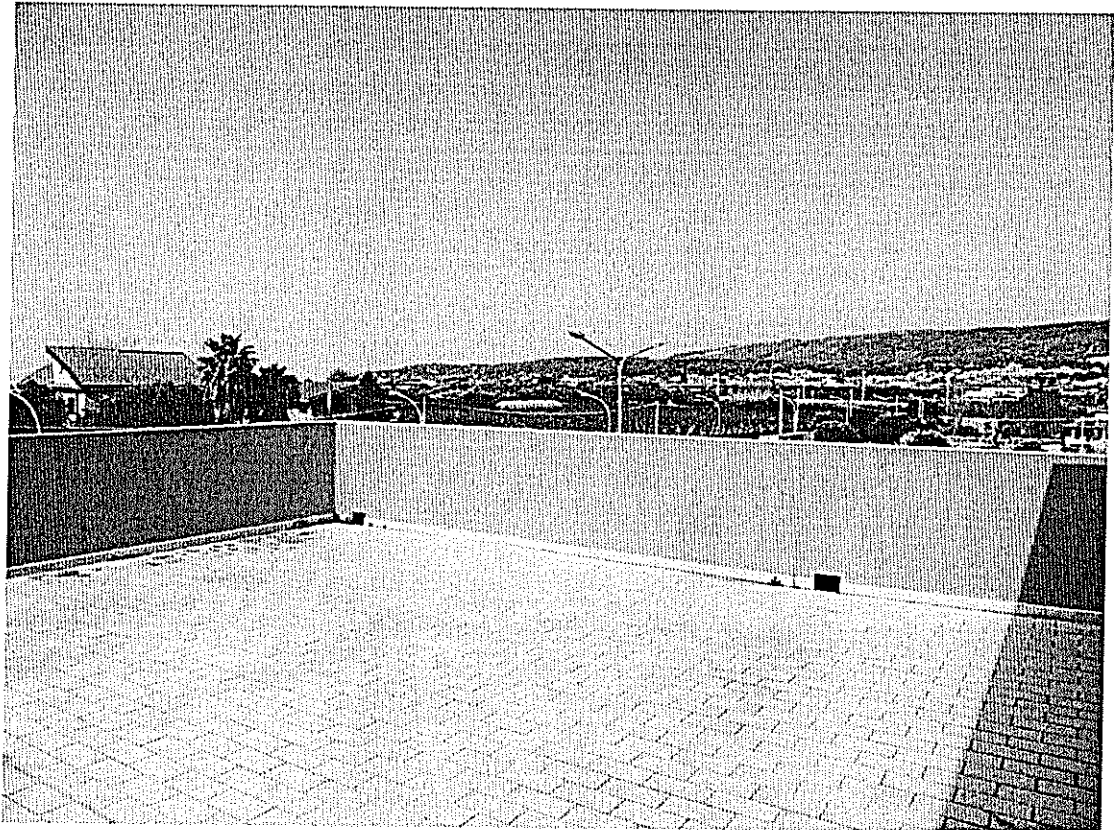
Terrazzo di pertinenza del primo corpo di fabbrica – piano secondo.
